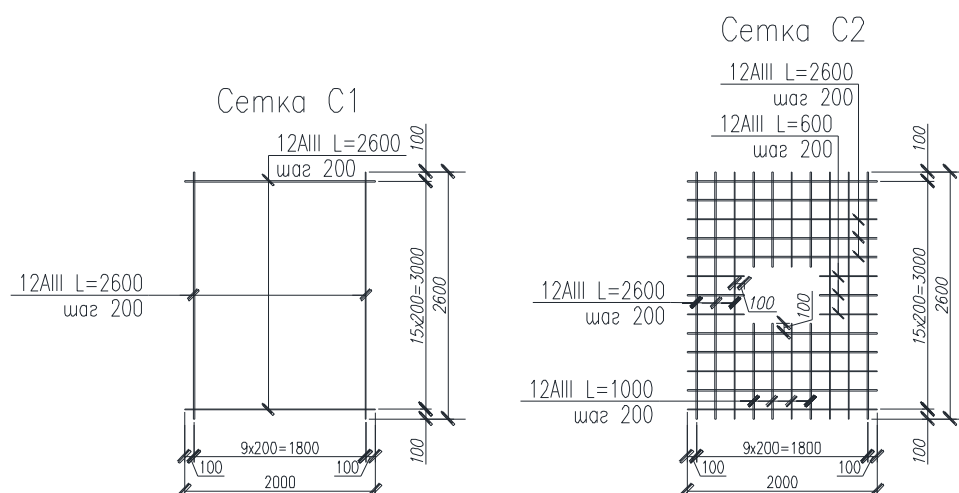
Сетка армирования плитной части фундамента
